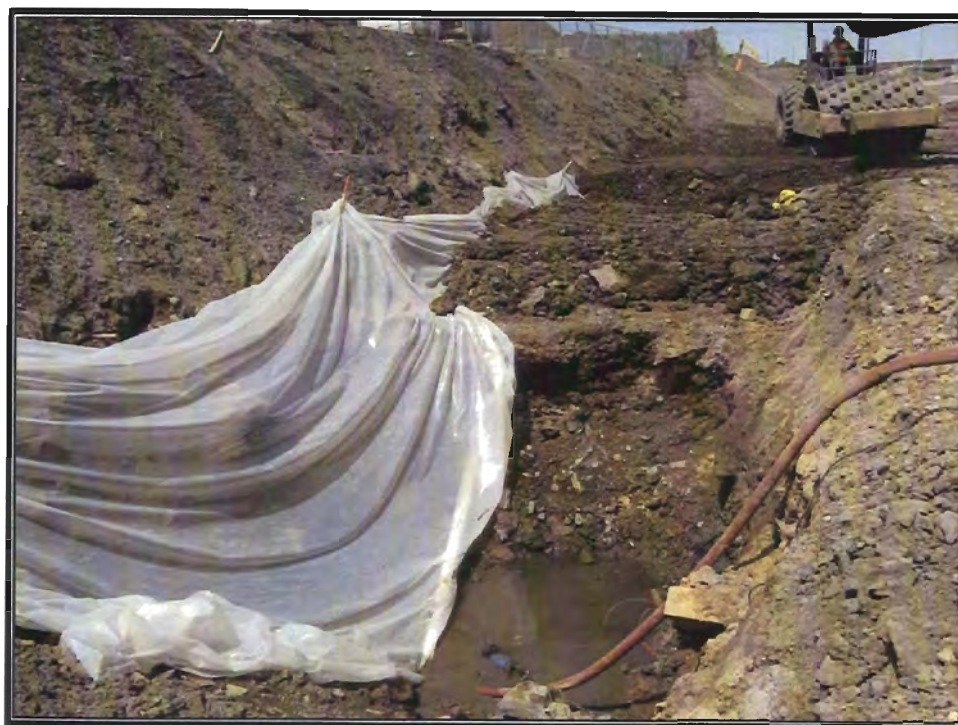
Excavation des sols du secteur de l'ancien site d'enfouissement EXC-02 et EXC-03.
